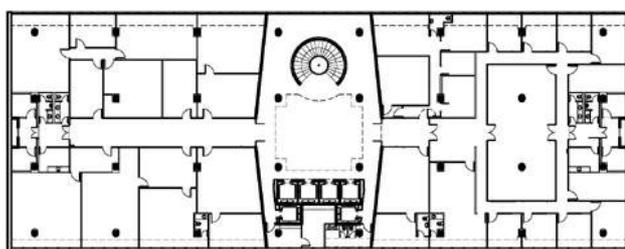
Planta baixa do 5º pav.: a densa ocupação dos setores, como padrão dos pavimentos tipo
